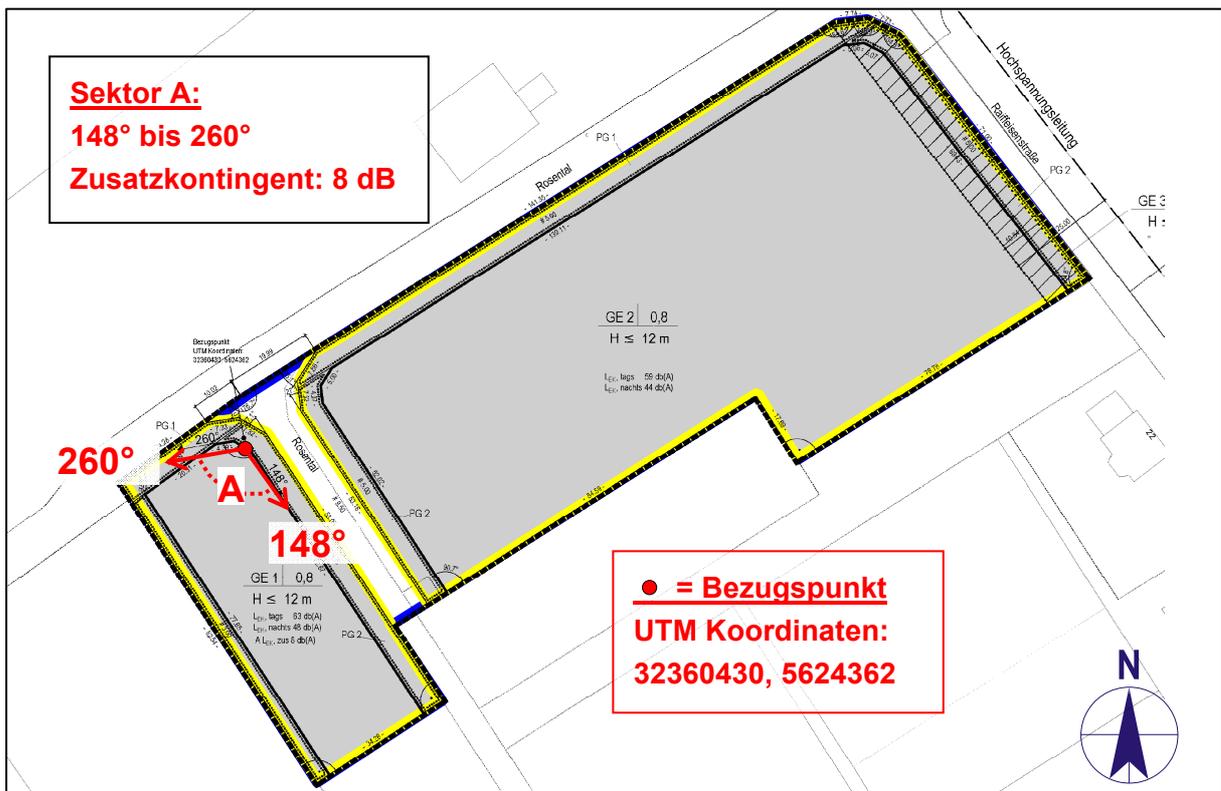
Richtungssektor mit einer Erhöhung der Emissionskontingente im Bebauungsplan Ro 24, Maßstab 1:1.750
